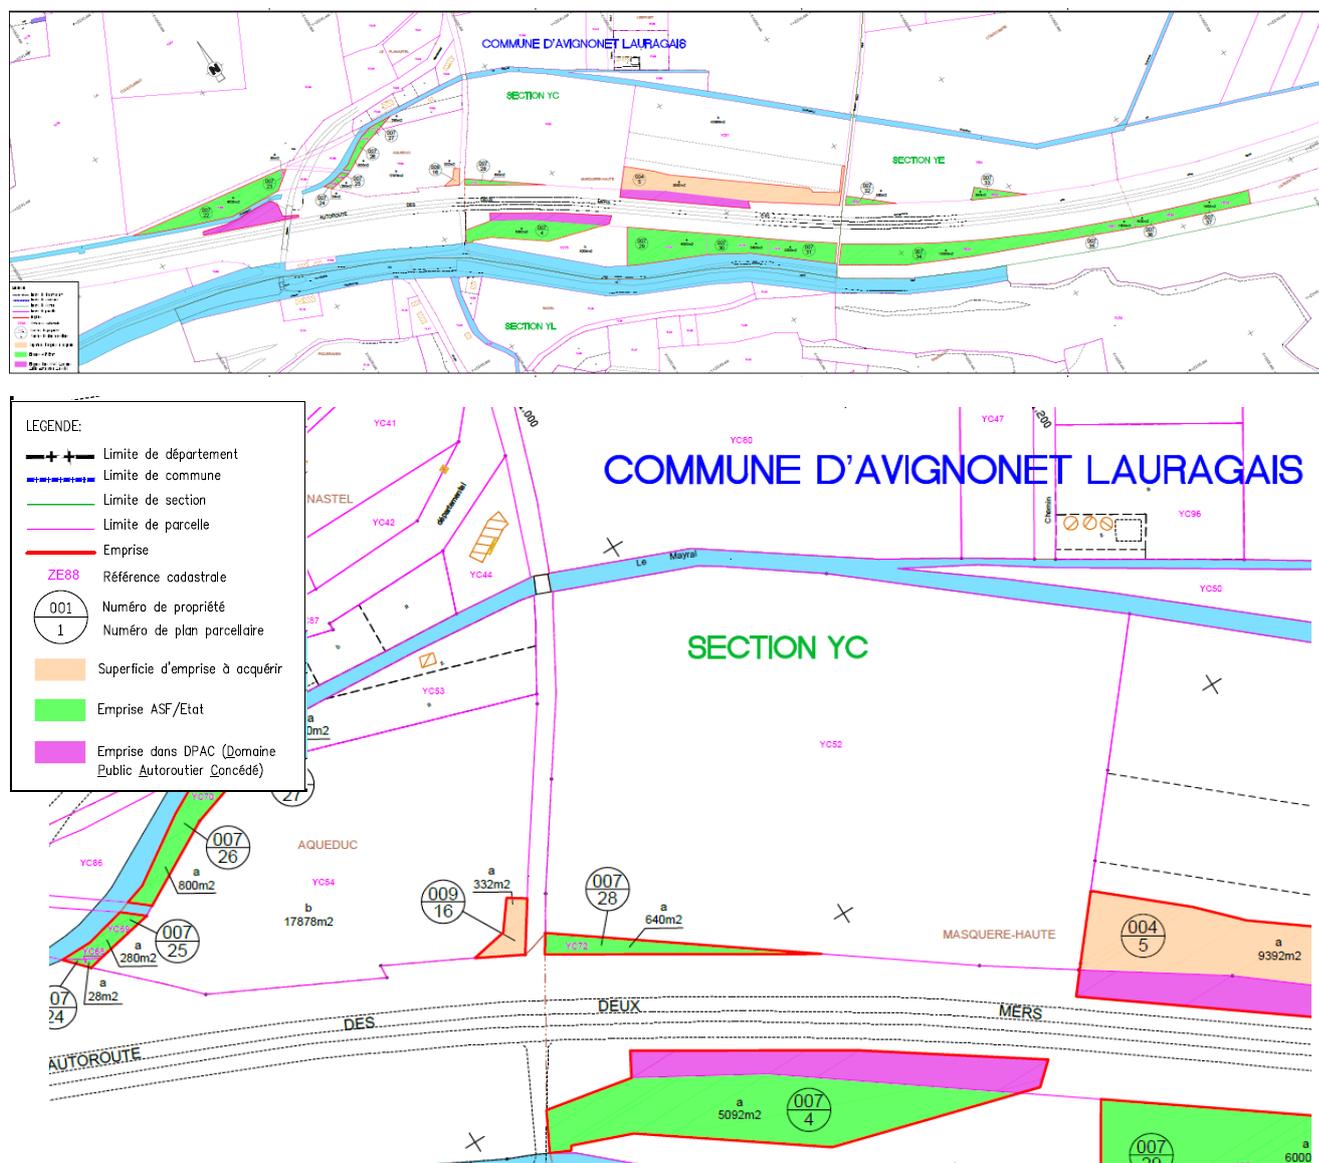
EXTRAIT DU PLAN PARCELLAIRE DU PROJET D'ELARGISSEMENT A 2X3 VOIES DE L'AUTOROUTE (SOURCE : ASF)
